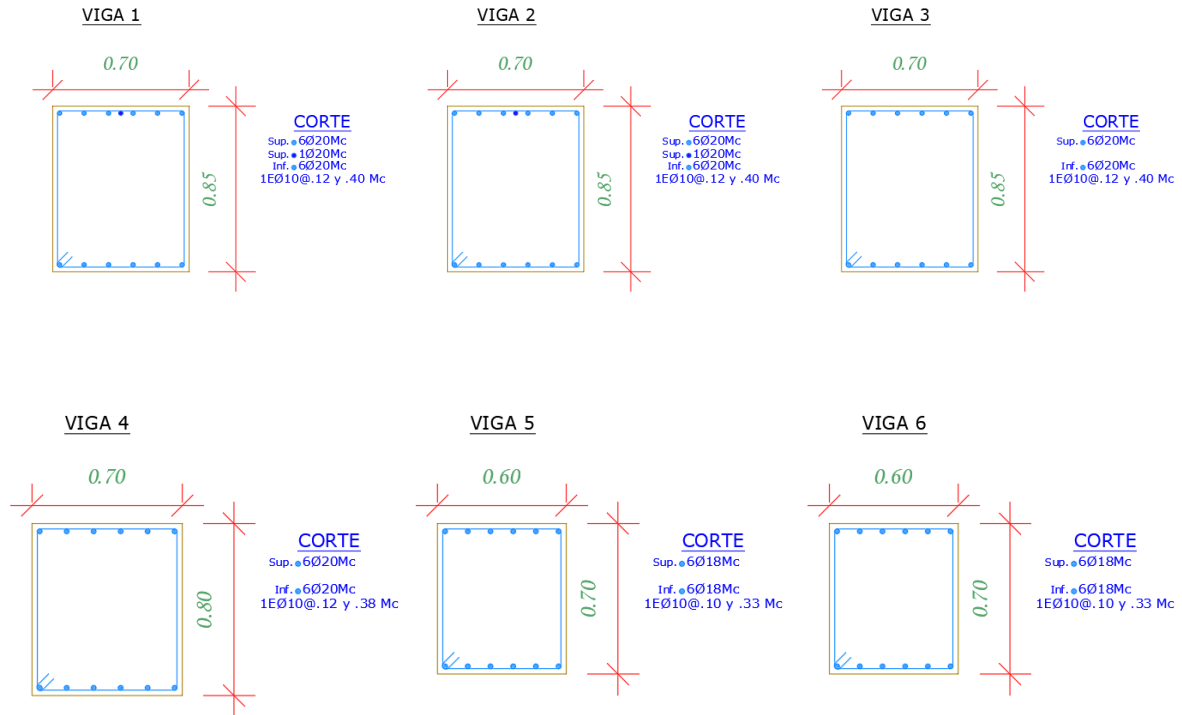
Secciones transversales de las vigas utilizadas en un edificio de 9 pisos
